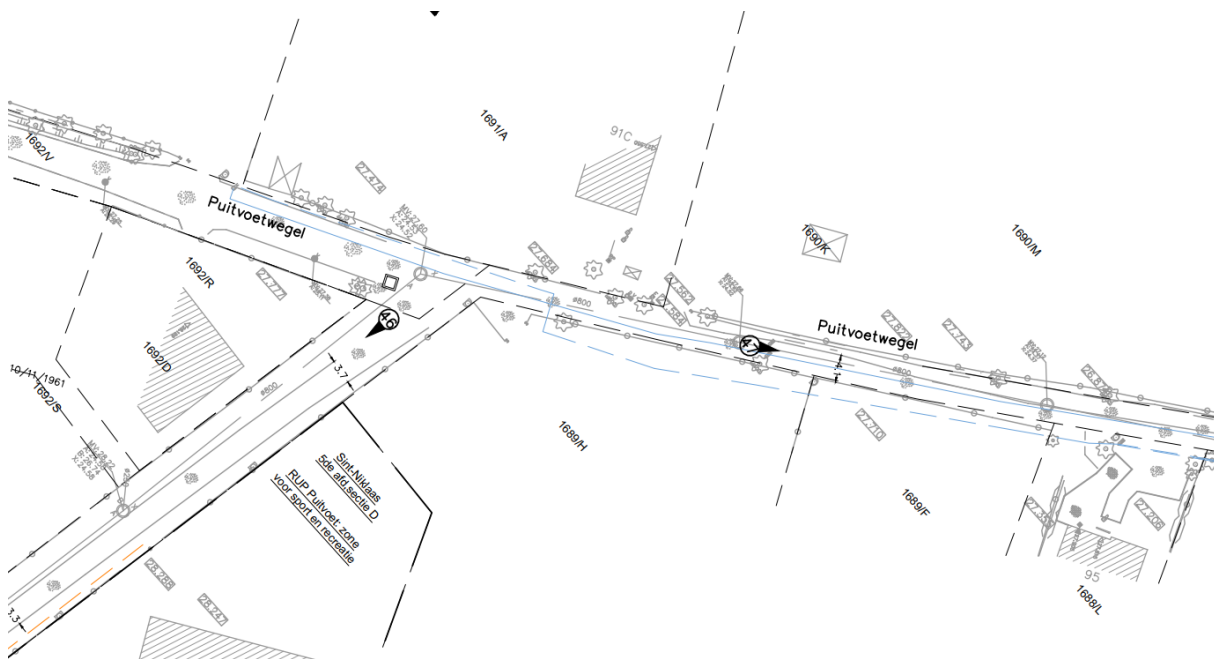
Uitsnede uit doorsnedeplan met bestaande toestand ter hoogte van het noordelijk deel van Industriepark-West
